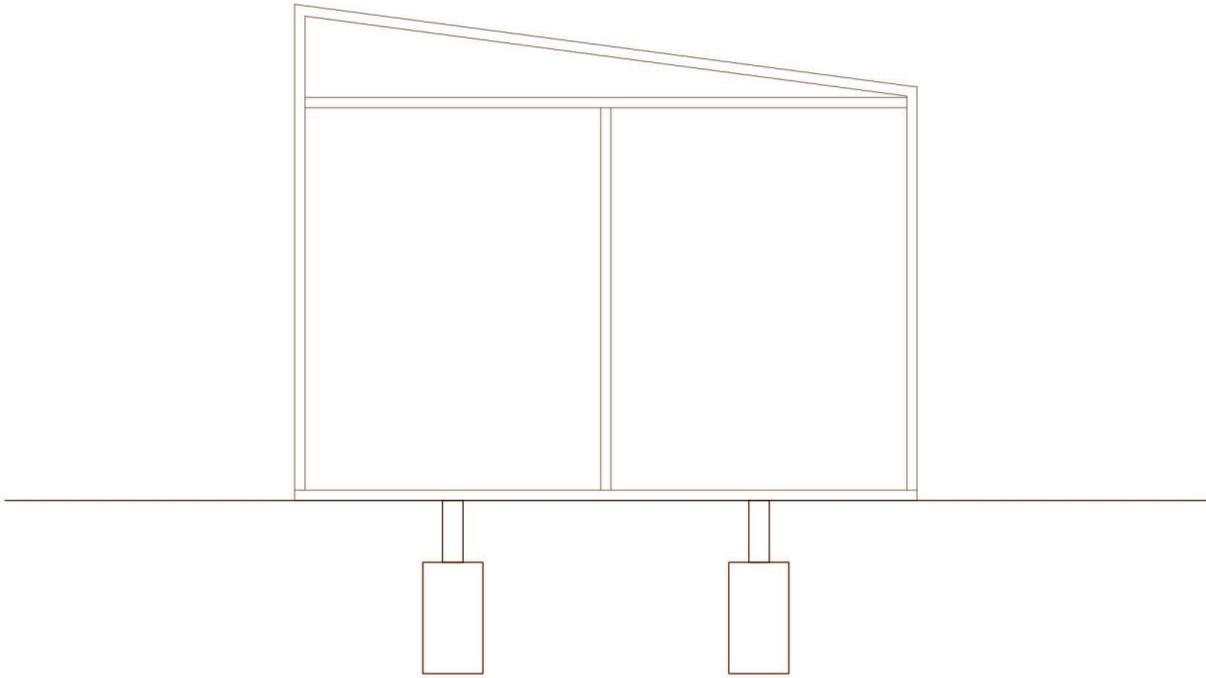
Esquema del paso 1 (armado de la estructura)
